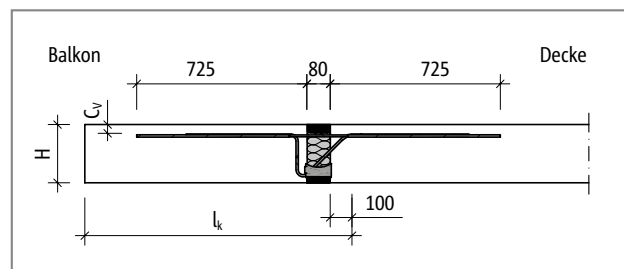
Schöck Isokorb® T Typ KL-M8 bis M12: Statisches System
